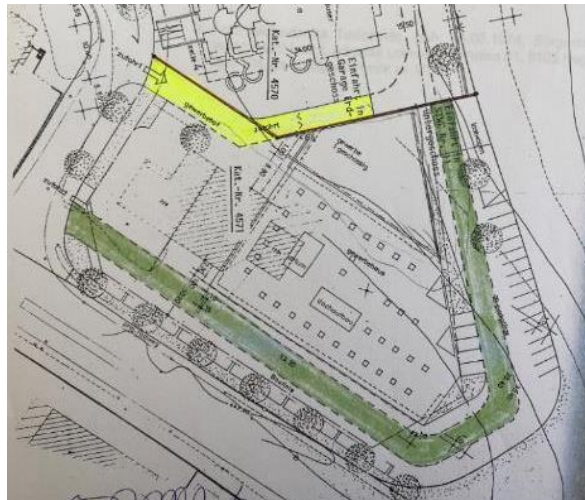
Ausschnitt Grundbuchauszug, Fuss- und Fahrwegrechte
